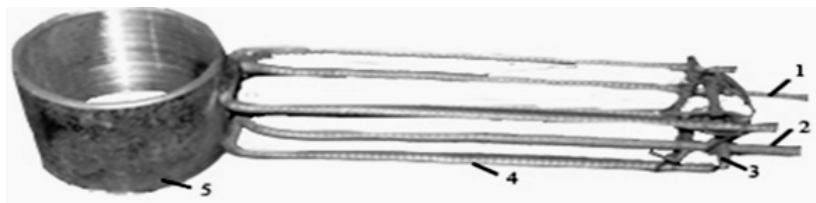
Соединение арматурного каркаса с концевой опорной втулкой арки: 1, 2 – арматурный каркас К-1; 3 – поперечная арматура; 4 – консольный стержень арматуры длиной ≈ 150 мм; 5 – концевая опорная втулка железобетонной арки.
